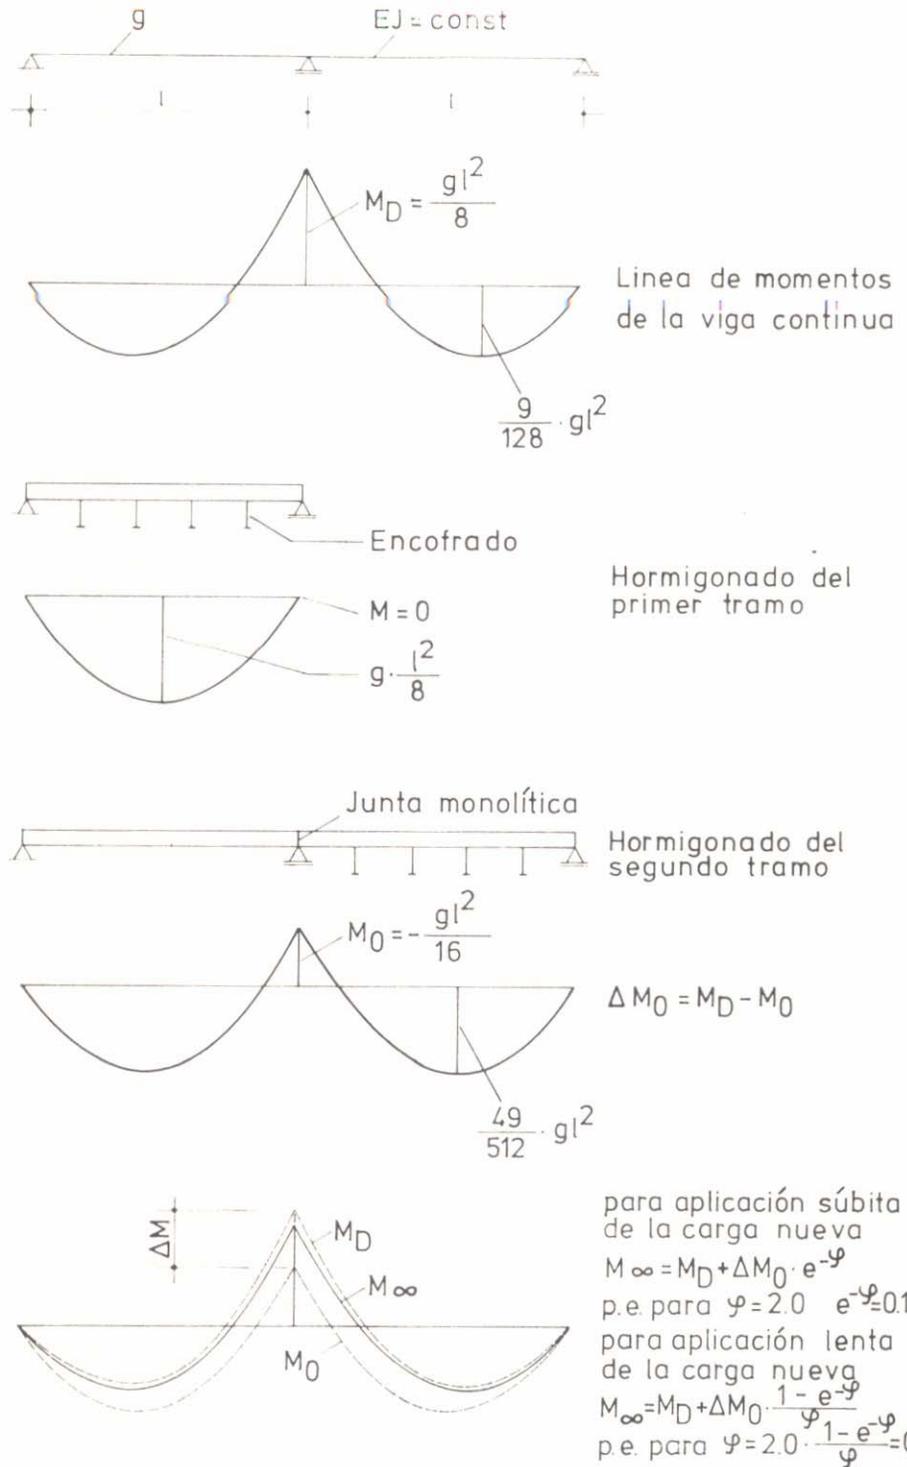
Línea de momentos flectores de una viga de hormigón construida en dos etapas.
